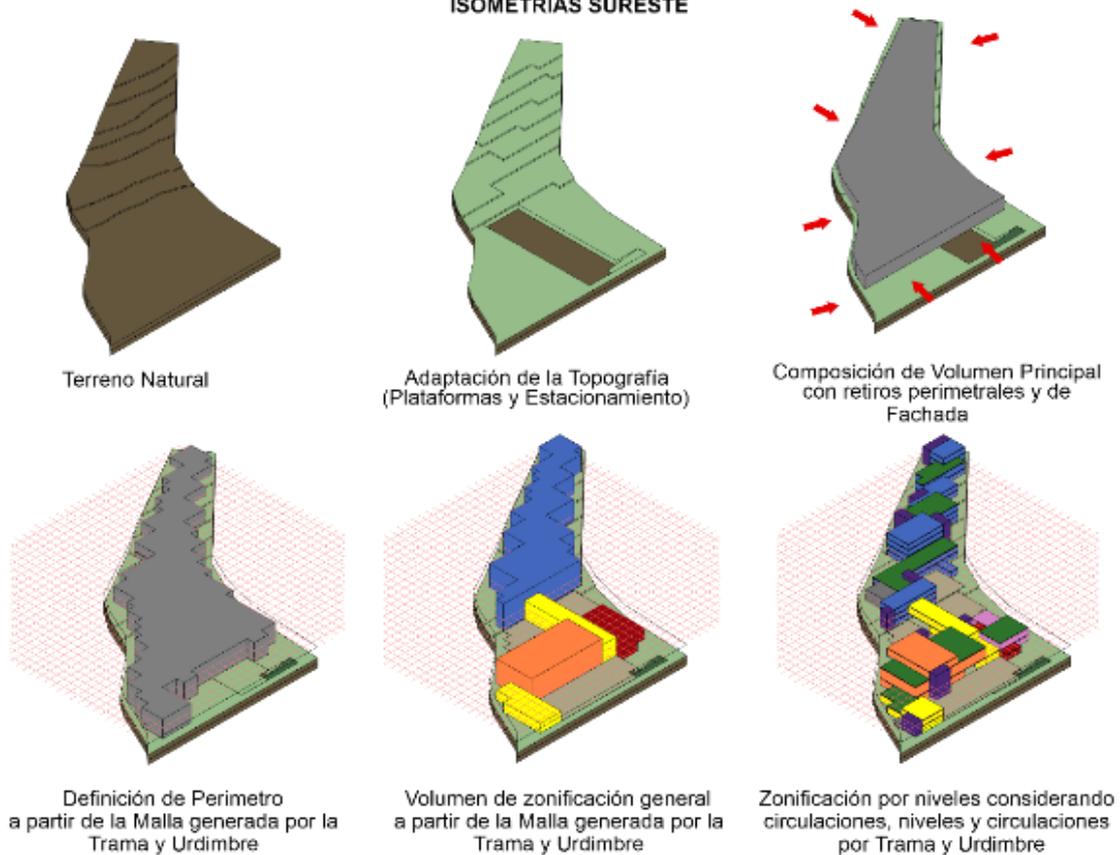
Esquematación en planta e isométrica del partido arquitectónico.
